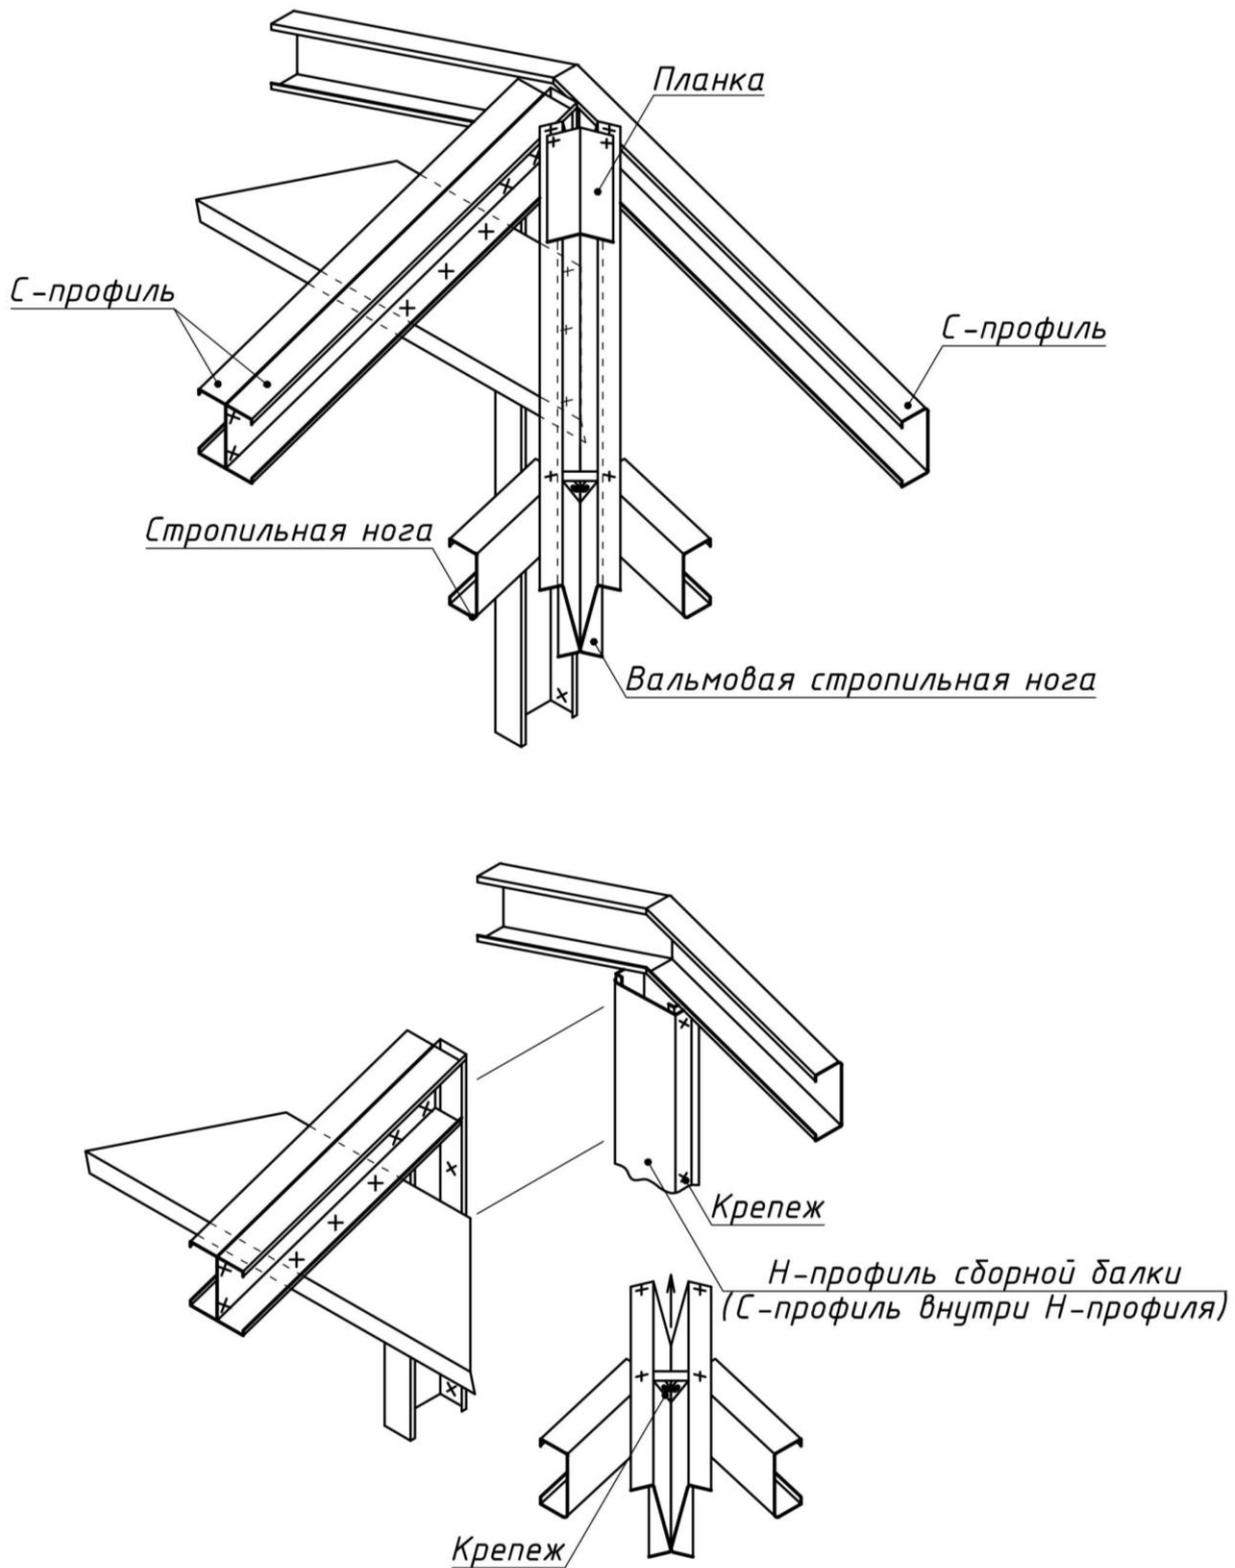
Узел К 13. Крепление вальмовой стропильной ноги
